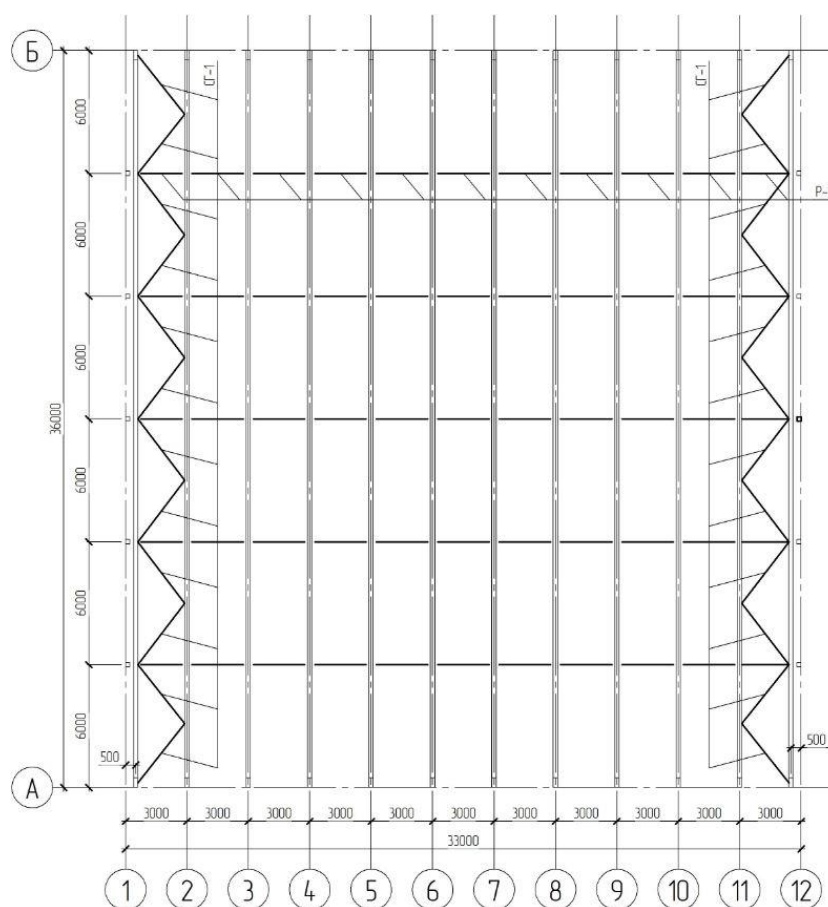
Схема расположения связей между стропильными фермами по верхнему и нижнему поясам
